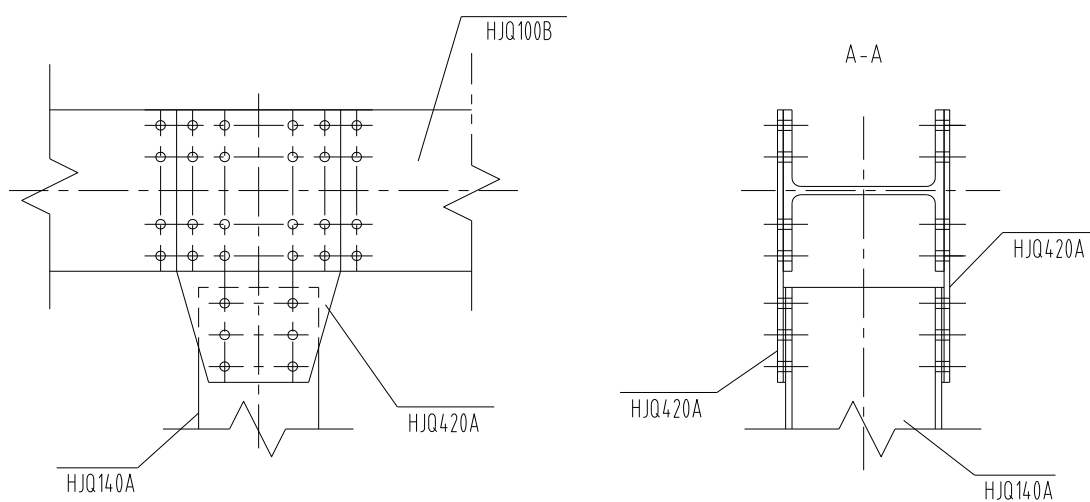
tabla detallada del ensamblaje de la unión A2
